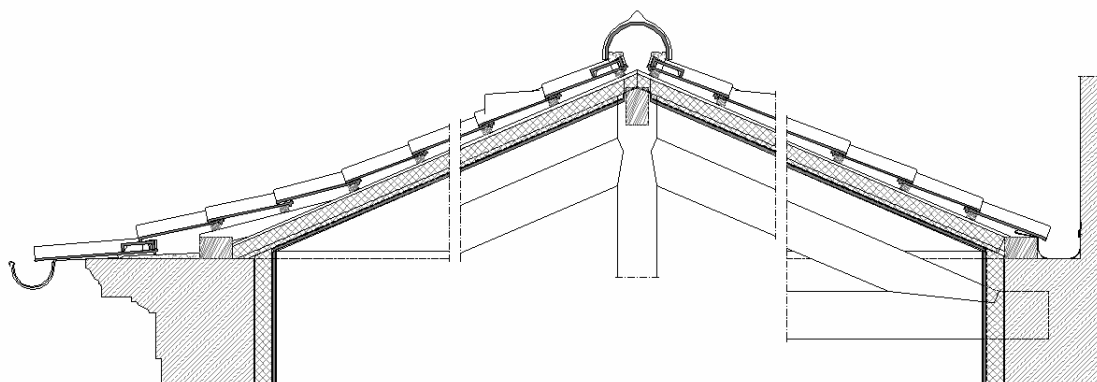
Solução de Isolamento térmico descontínuo entre as varas da estrutura do telhado.
